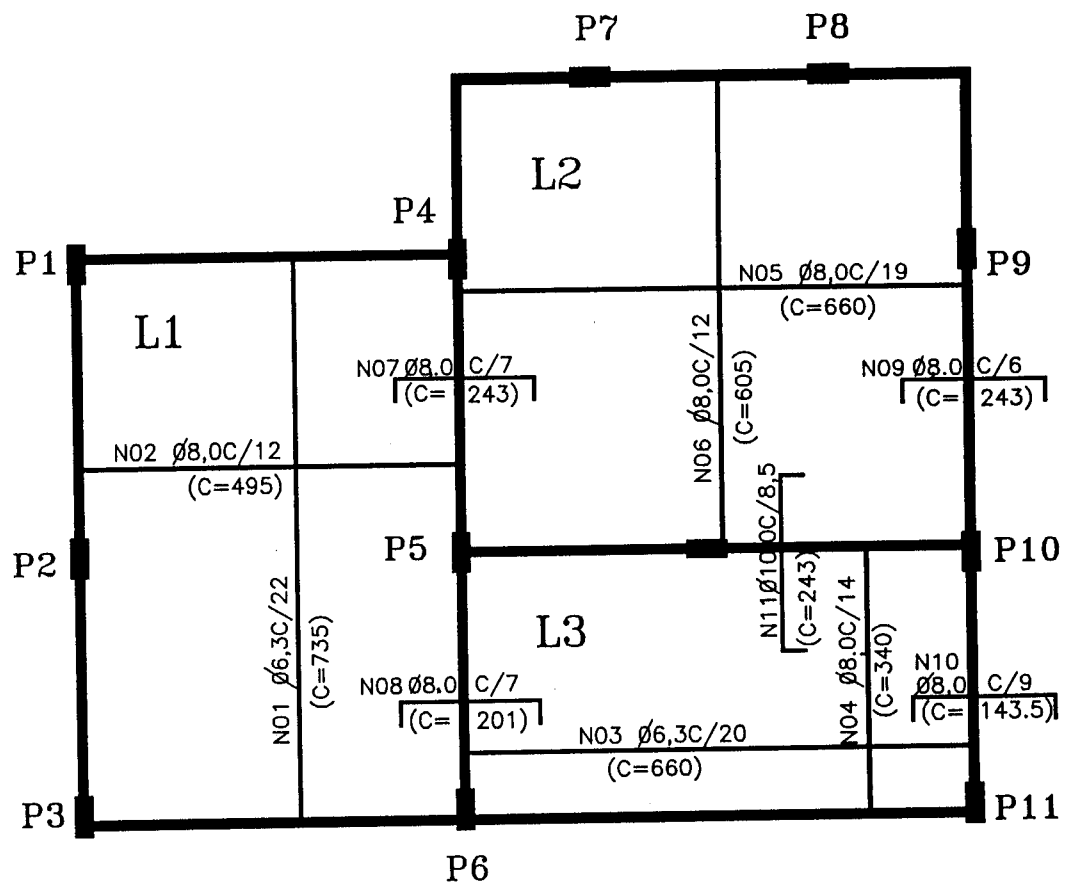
DESENHO ESQUEMÁTICO DAS ARMADURAS - ESTRUTURA 2.2
